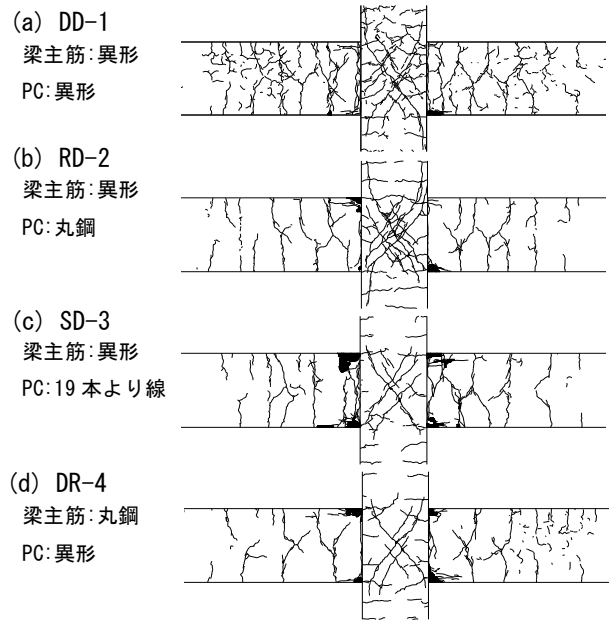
ひび割れ状況 (層間変形角 3%)
